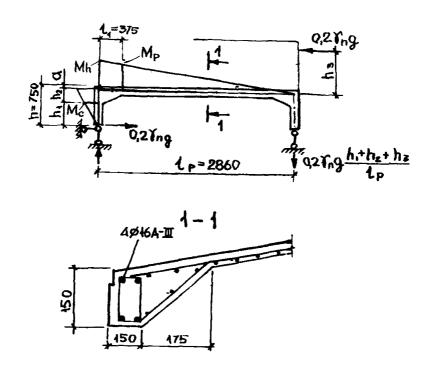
К расчету опорного поперечника торцовой рамы панели-оболочки на нагрузки, возникающие при транспортировании а-вид на опорный поцеречник торцовой рамы; б-поперечное сечение торцового ребра
